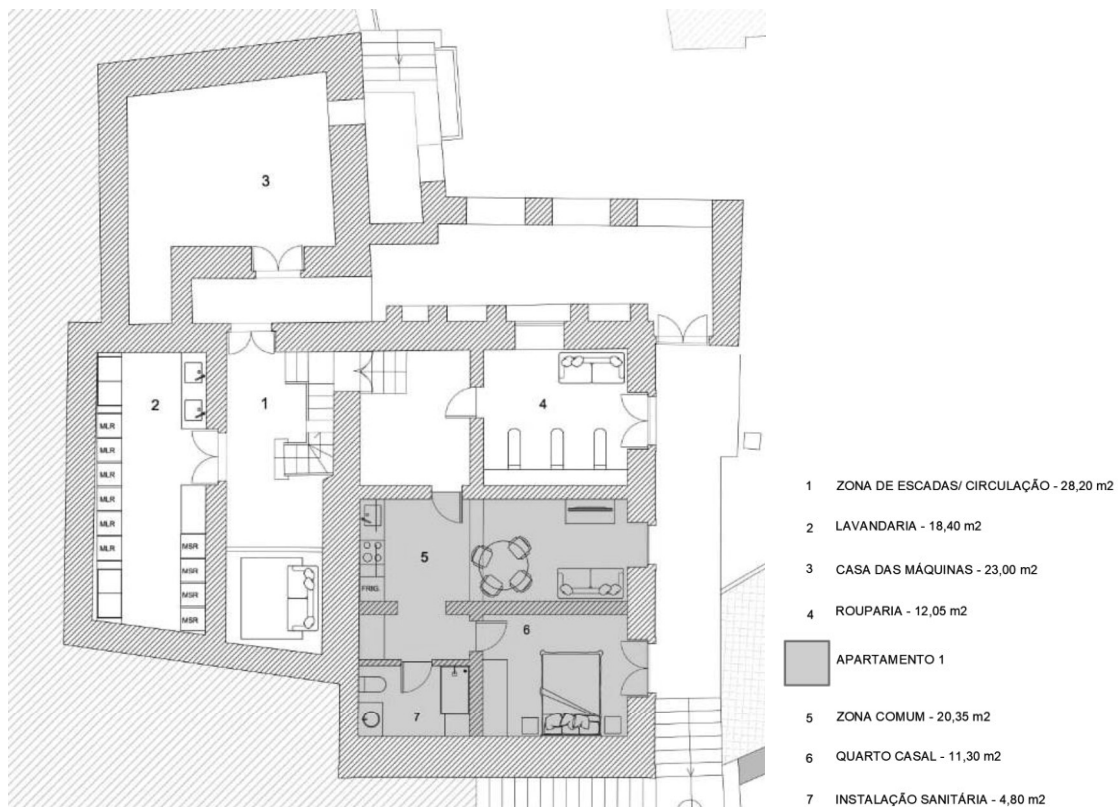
Planta Final zonamentos, Piso -1 (s/ escala) | Beatriz Figueiredo
